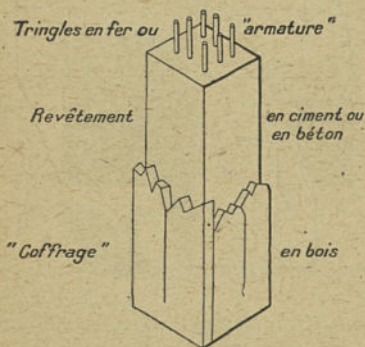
Exécution d'un pilier en béton armé ; une partie du coffrage est enlevée.
